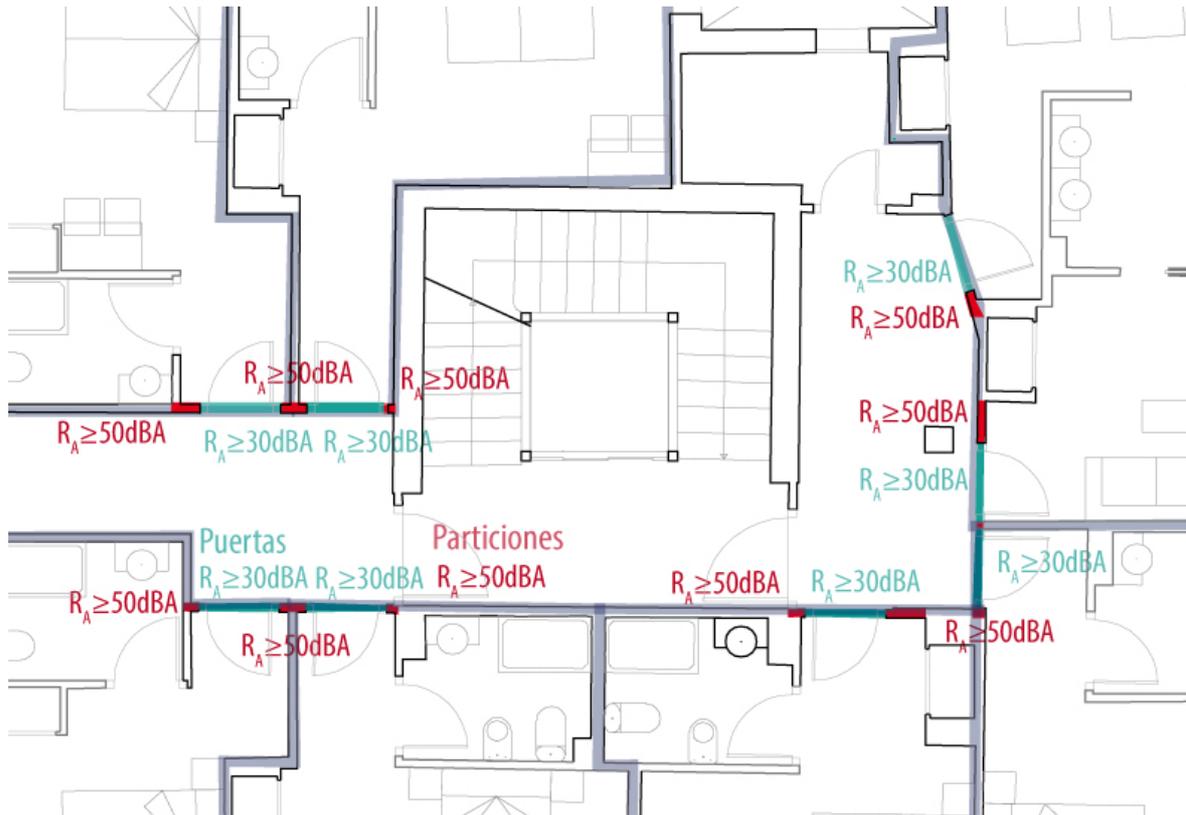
Detalle planta tipo. Valores de aislamiento a ruido aéreo exigidos a los elementos de separación verticales con puertas.
